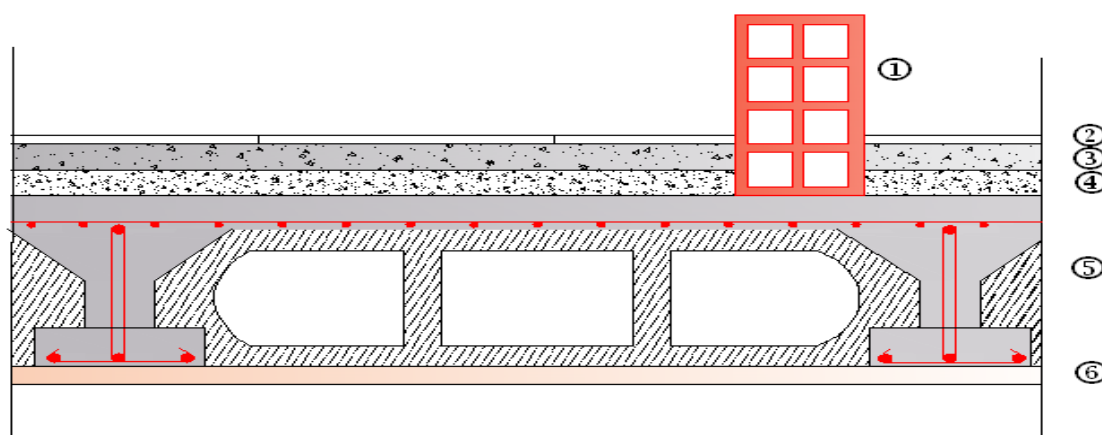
Coupe verticale d'un plancher étage courant (corps creux)
